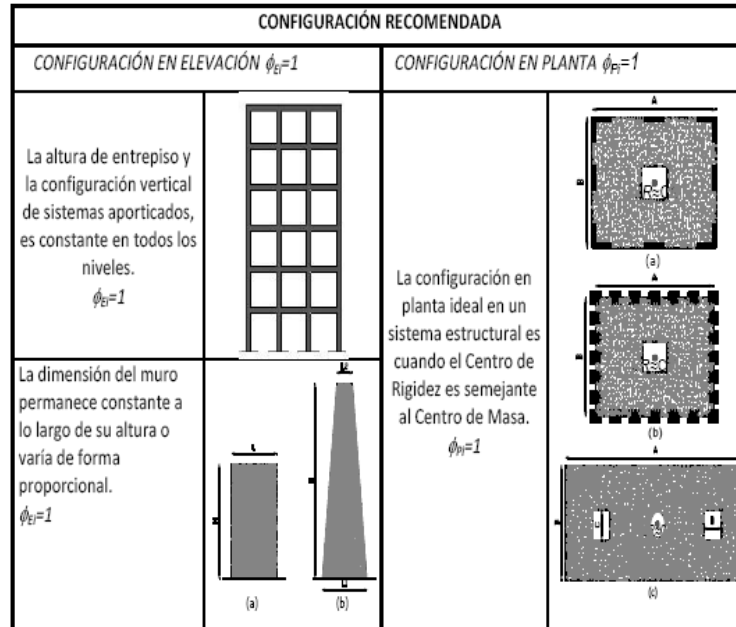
Estructuras regulares en planta y elevación
